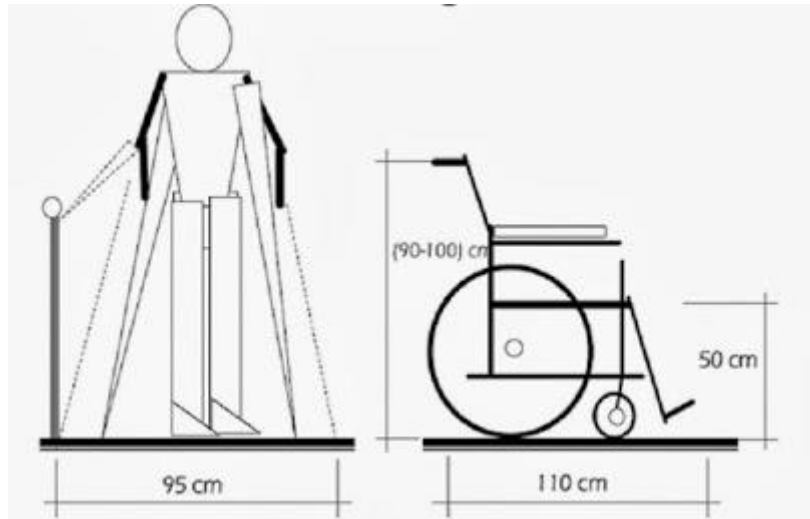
Gambar Kebutuhan Ramp & Handrail
